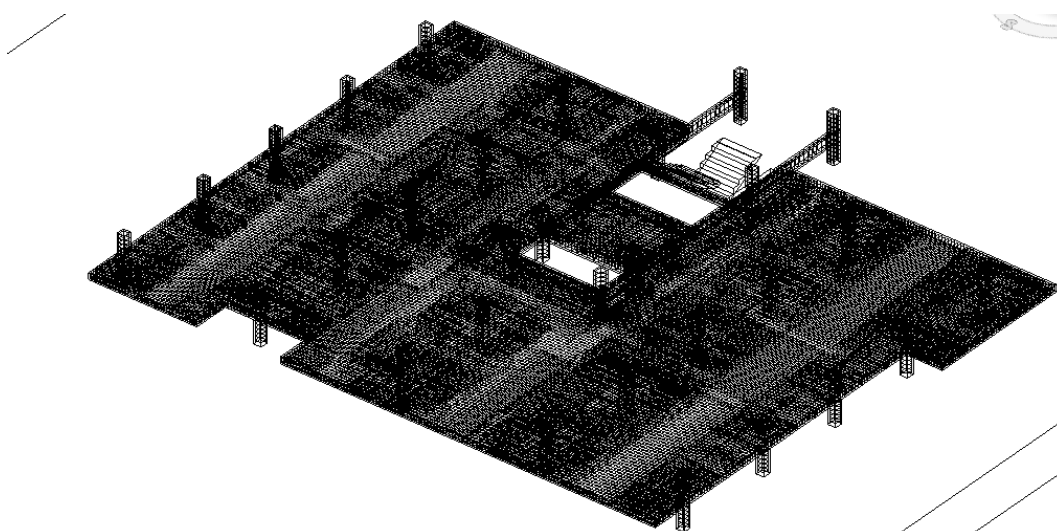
Detalhe da armadura da laje do rés-do-chão (solução estrutural 1) no Revit.
